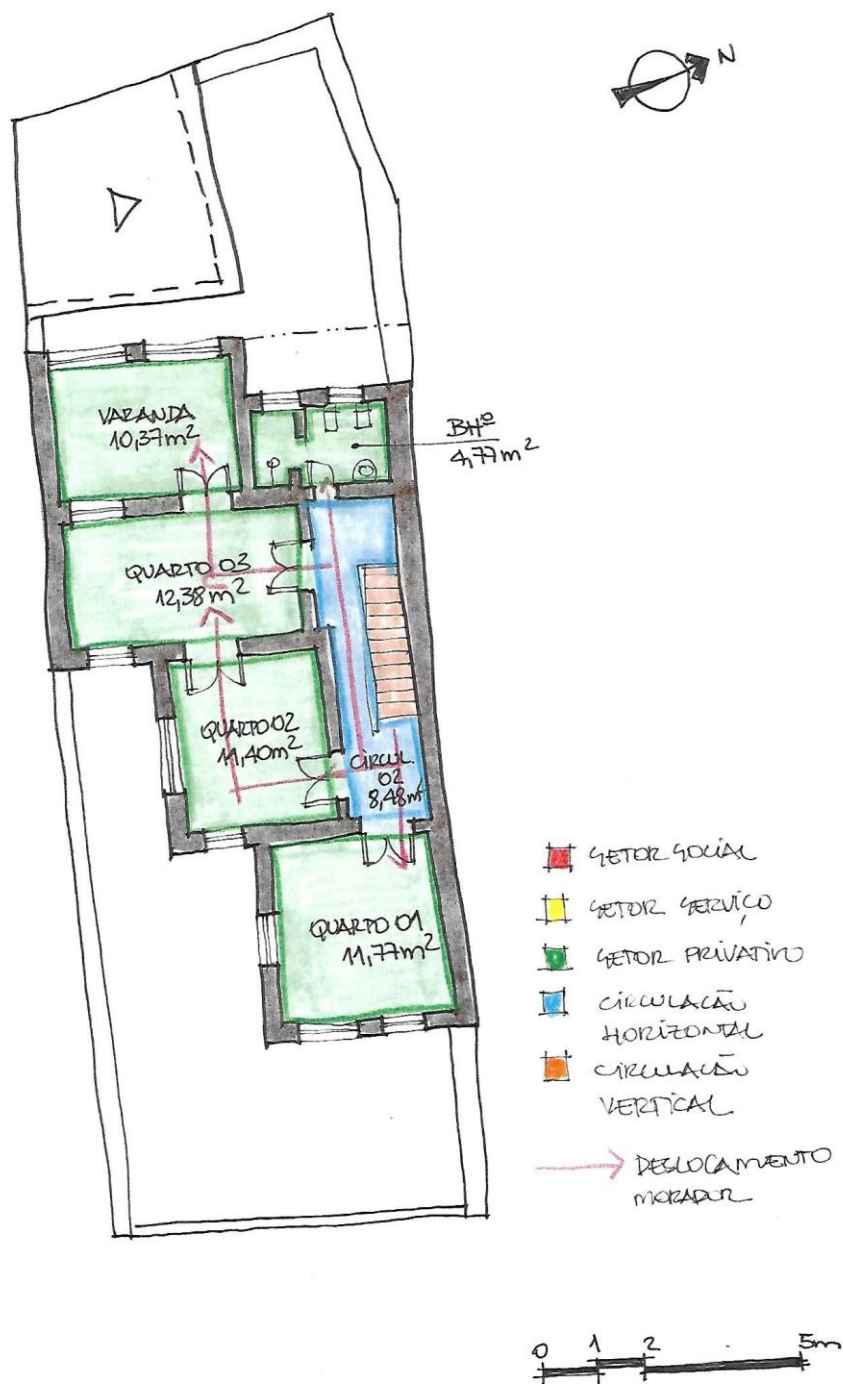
Planta do pavimento superior da Residência Nº 226. Fonte: autora, 2019.
